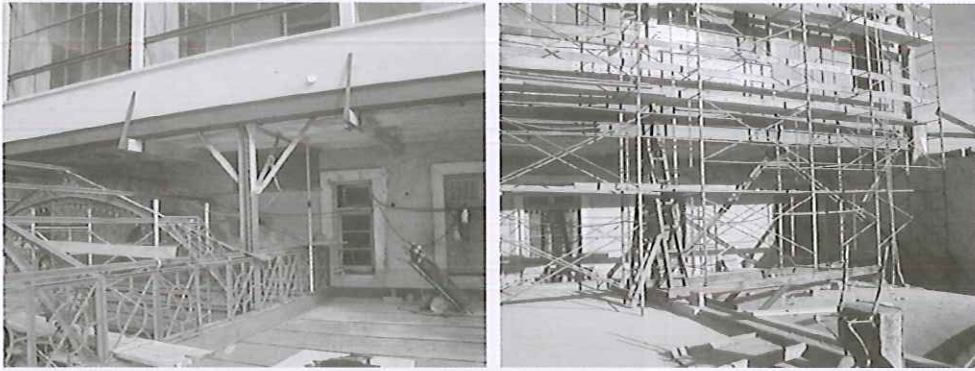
, 27 y 28 – Apuntalamiento de fachada y colocación del perfil - Esquema estructural de la solución
